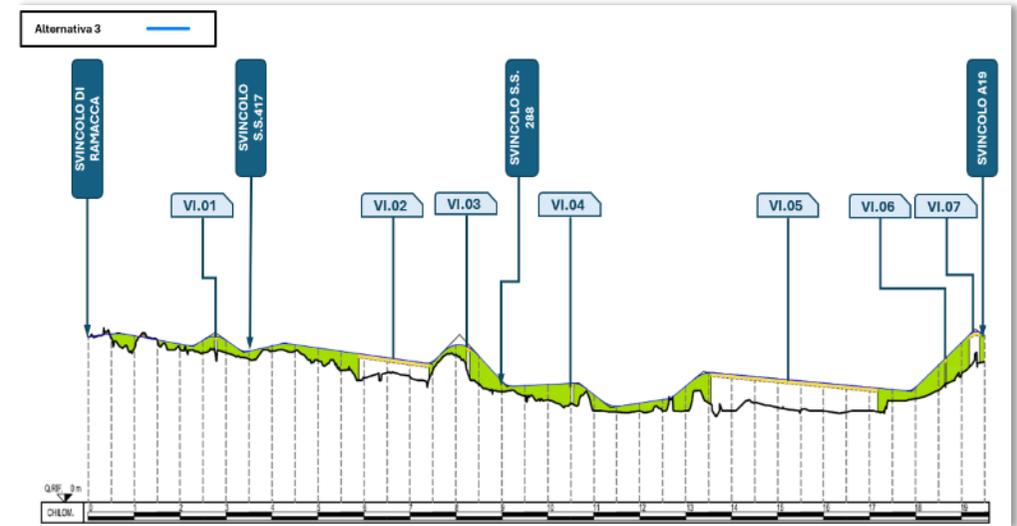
PROFILO LONGITUDINALE DI PROGETTO - ALTERNATIVA 3
